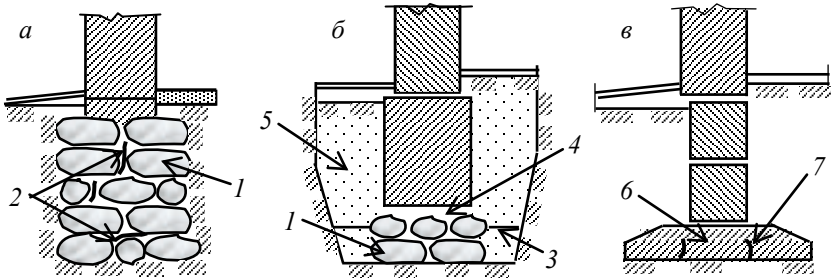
Пошкодження фундаментів: *а* – розшарування бутового мурування; *б* – розрив фундаменту; *в* – тріщини у фундаментній плиті; 1 – бутове мурування; 2 – місця розшарування мурування; 3 – рівень промерзання ґрунту; 4 – розрив фундаменту; 5 – засипка пазух фундаменту; 6 – фундаментна залізобетонна плита; 7 – тріщини у фундаментній плиті
